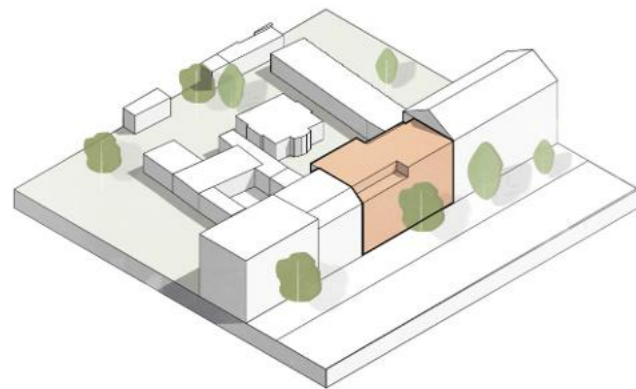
Baulückenschließung - Beispiel: Bernauer Straße
